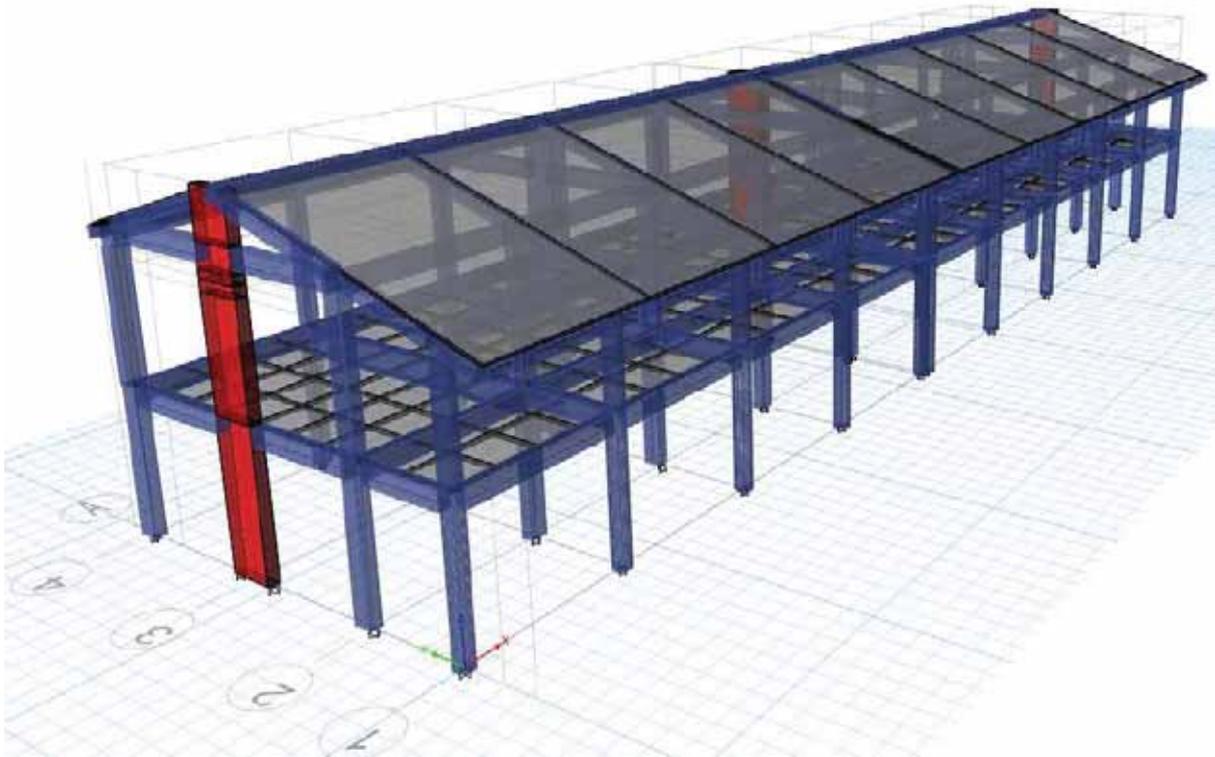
Referencias para diseñar elementos frame, vigas y columnas
